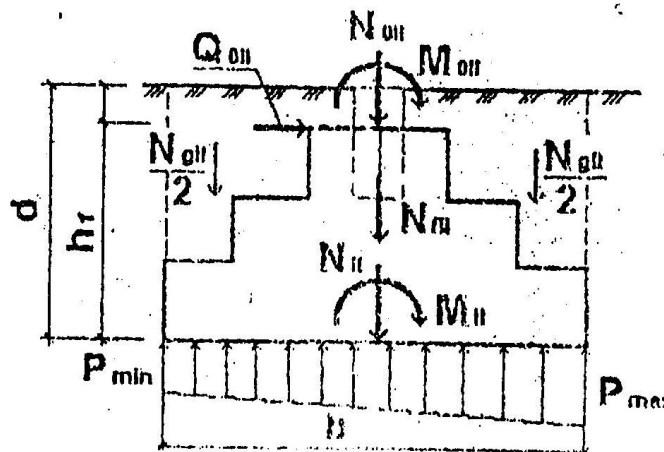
Расчетная схема к определению размеров подошвы фундамента.
